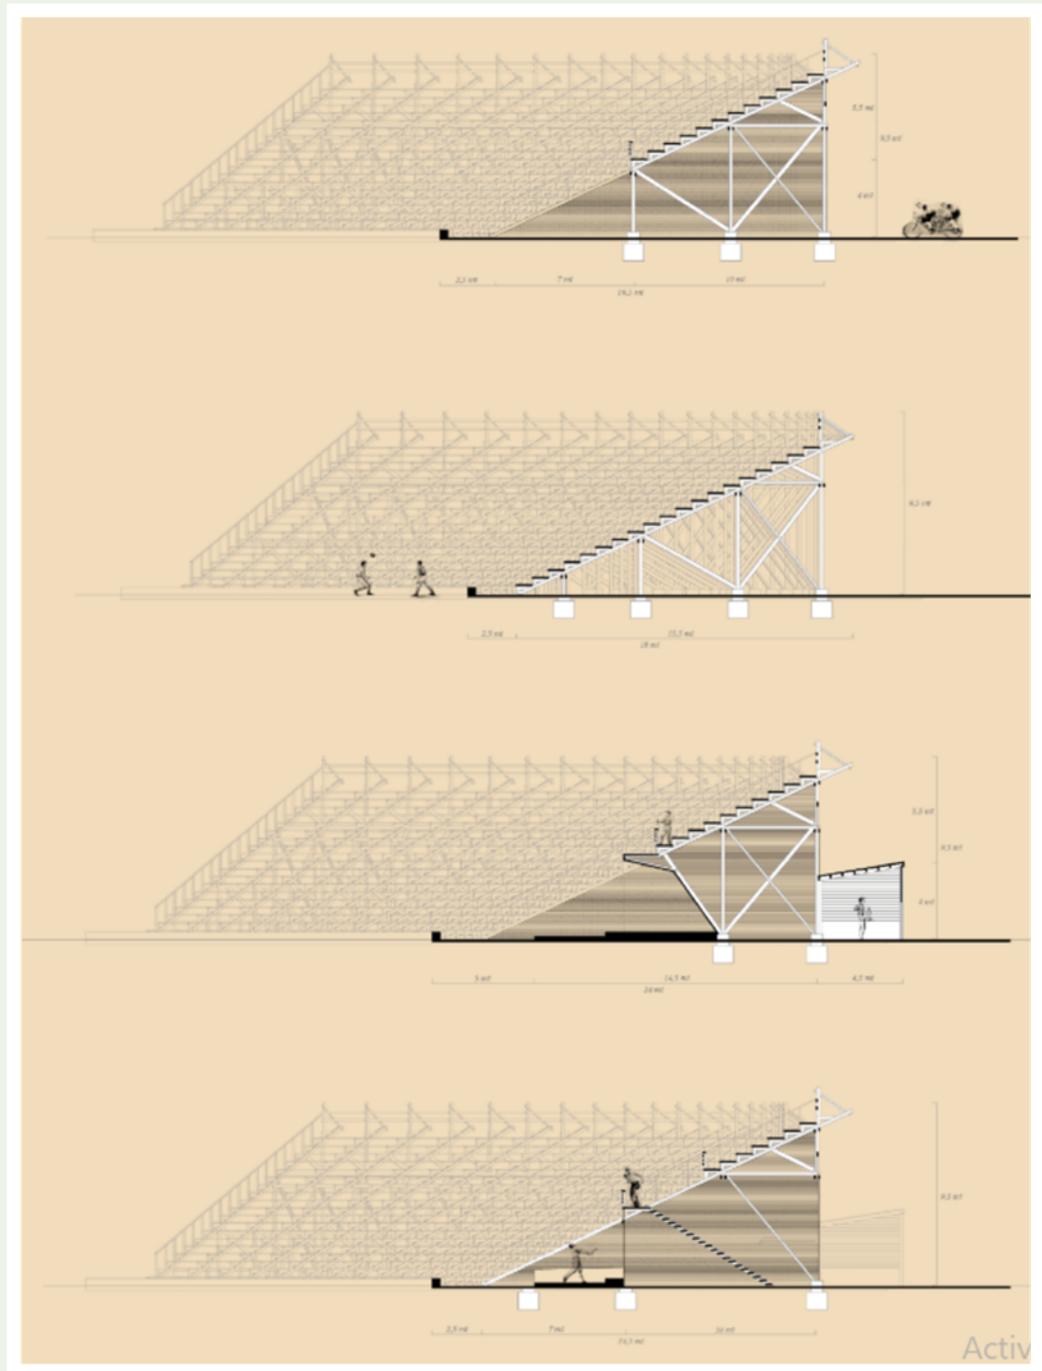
Planimetría reconstrucción Estadio San Eugenio. Elaboración propia.
